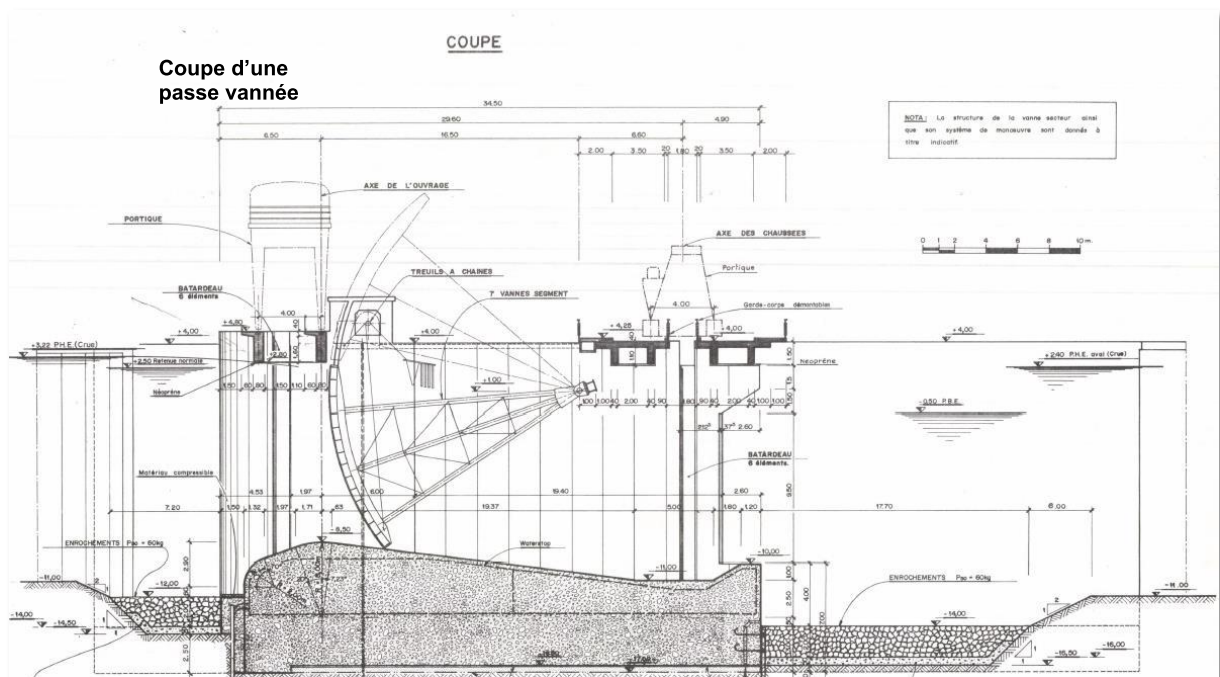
Extraits de plans du barrage de Diama (coupe passe vannée)
